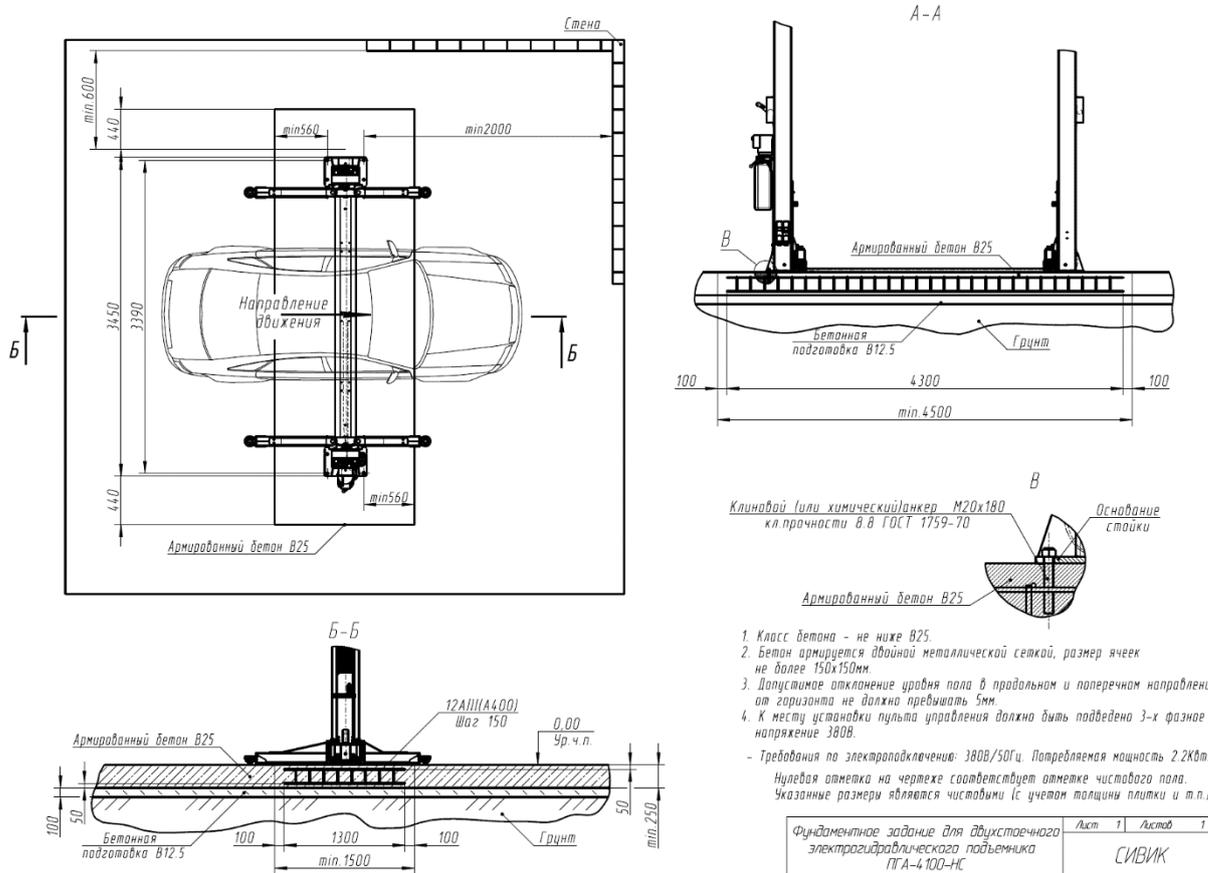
Схема оборудования фундамента для крепления подъёмника
